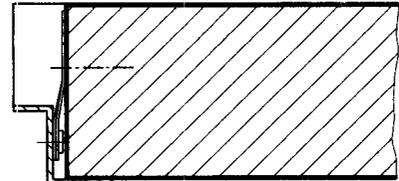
Zargenanker, Einbaubeispiel (Grundriß) dünne Wand, nur Leibungsfläche geputzt, Dübelbefestigung nur auf der Leibung, versetzte Lage der beiden Zargenankerteile
